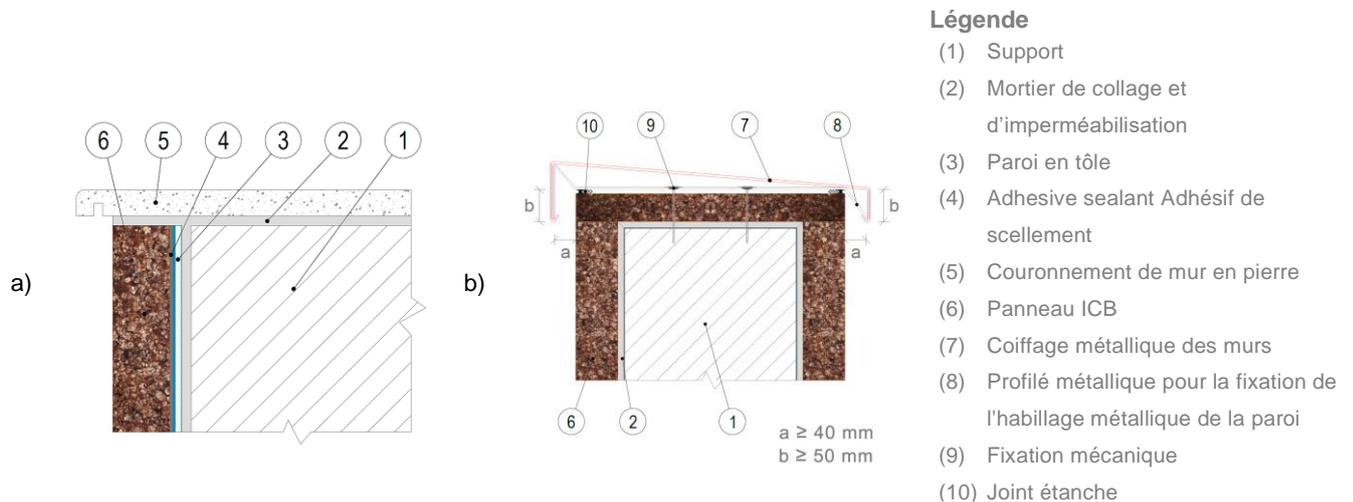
Recouvrement de paroi: a) Coupe transversale du couvercle supérieur; b) Recouvrement de paroi métallique.
